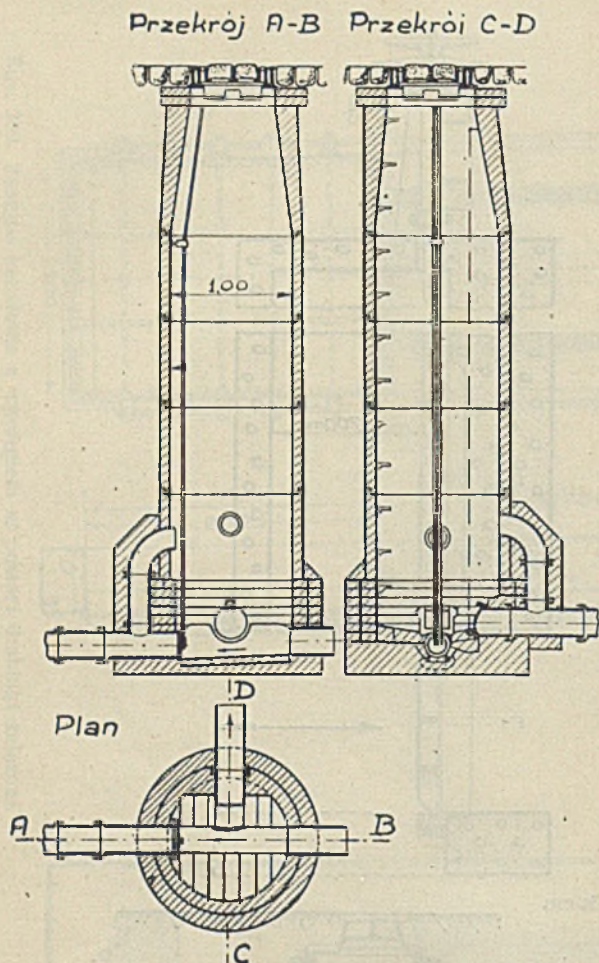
Zasuwa kanałowa poruszana ślinkiem elektrycznym.
